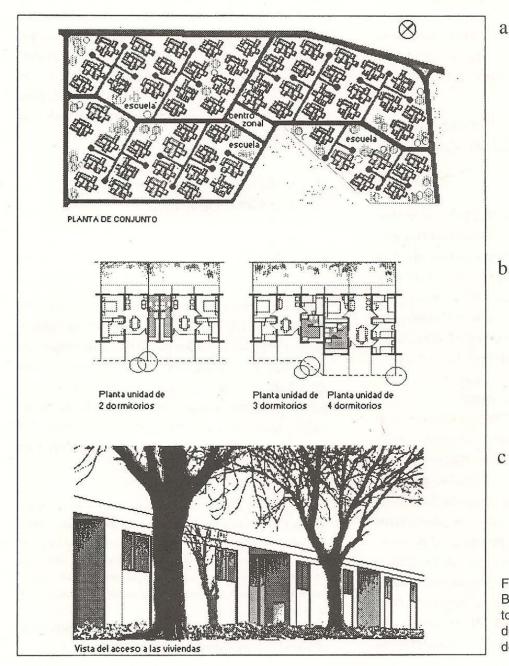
Conjunto Ciudad Gral. Belgrano. a) Planta de conjunto. b) Plantas de las unidades de 2, 3 y 4 dormitorios. c) Vista del acceso a las viviendas.
